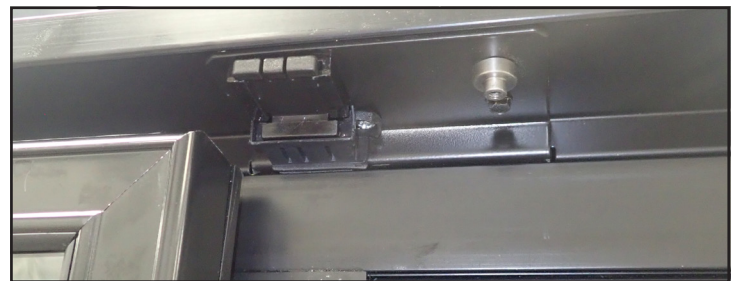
Tapa del pasador de la bisagra instalado en el lado opuesto.
